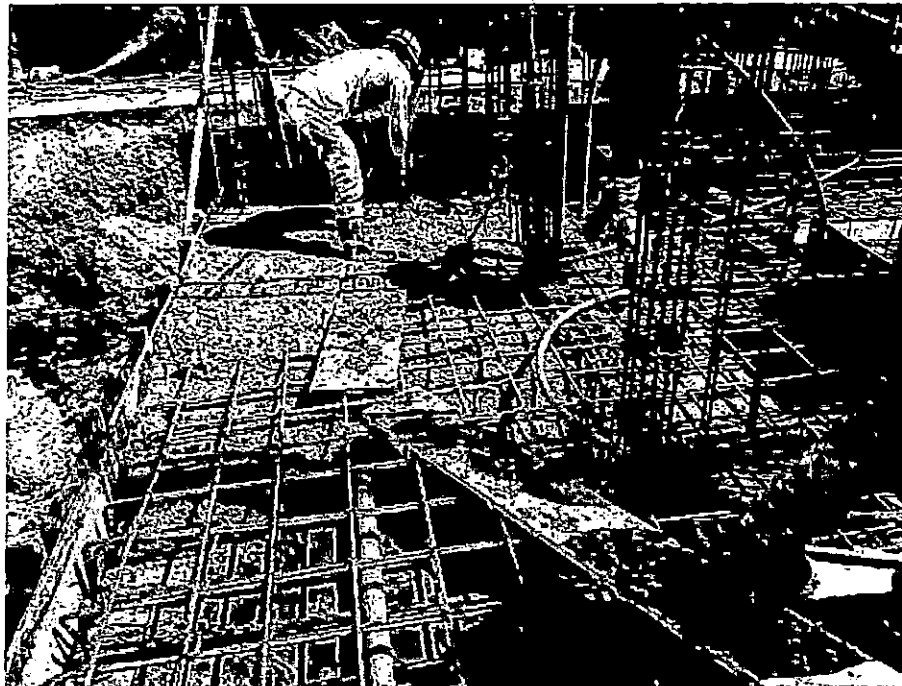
Vaciado de concreto en losa de techo – Cisterna de agua potable
